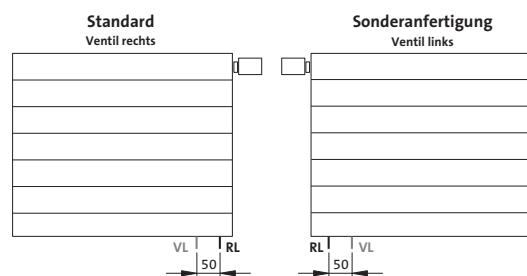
Anschlusslage Ventil rechts oder Ventil links
